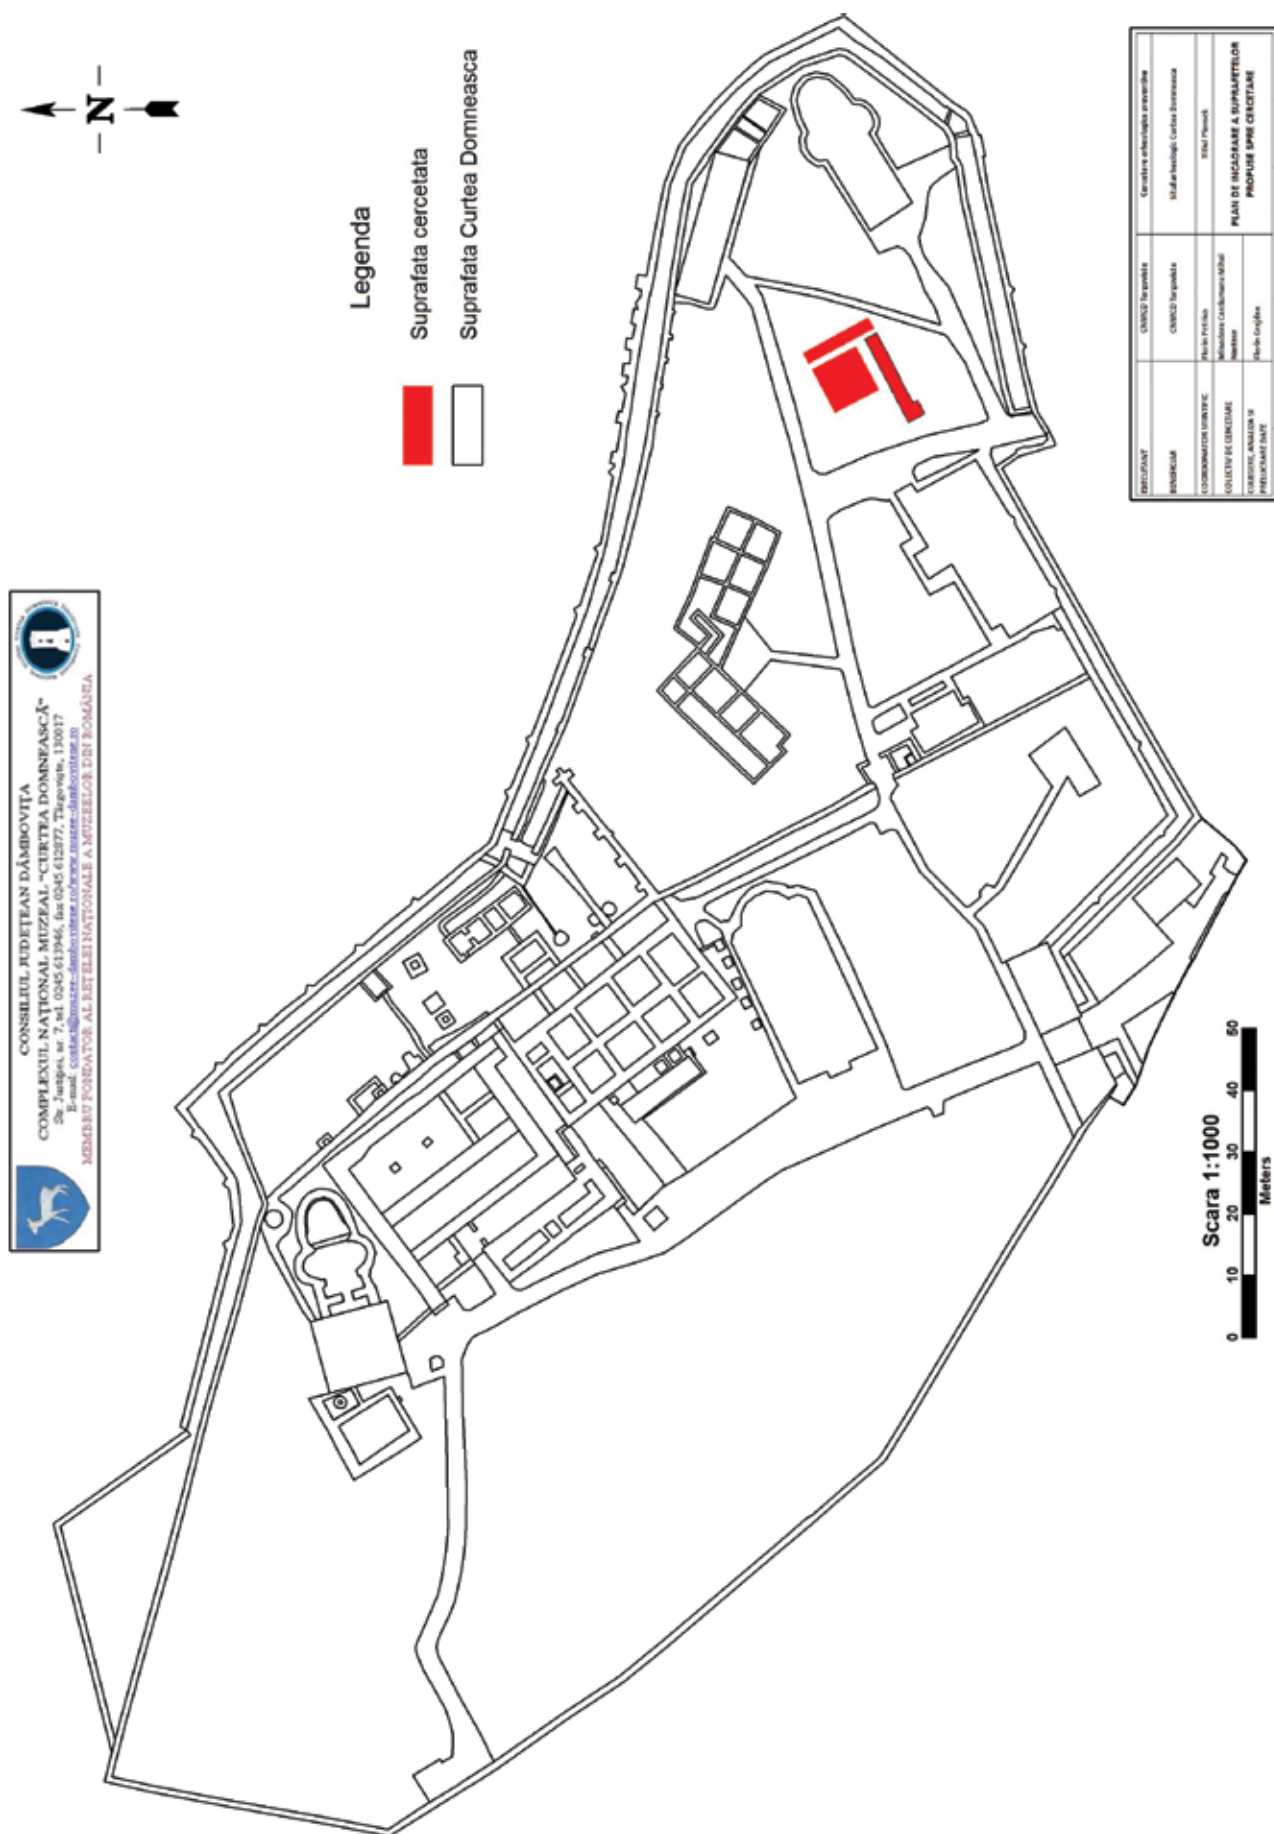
Plan A4 încadrare, scara 1:1000, fără grid.
